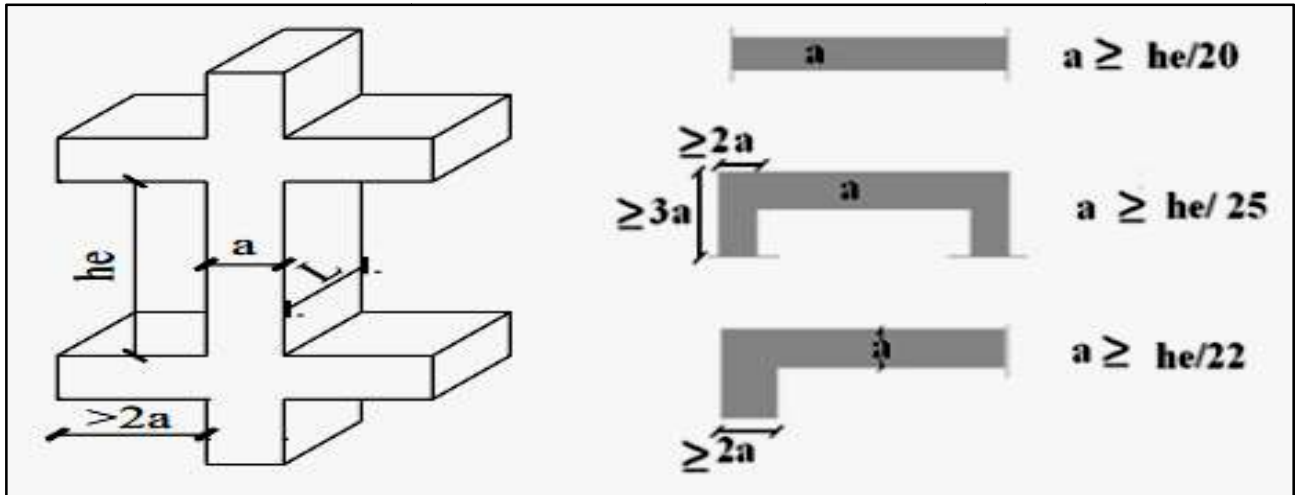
Coupe de voile en plan (droite) Voile en 3D (gauche).
